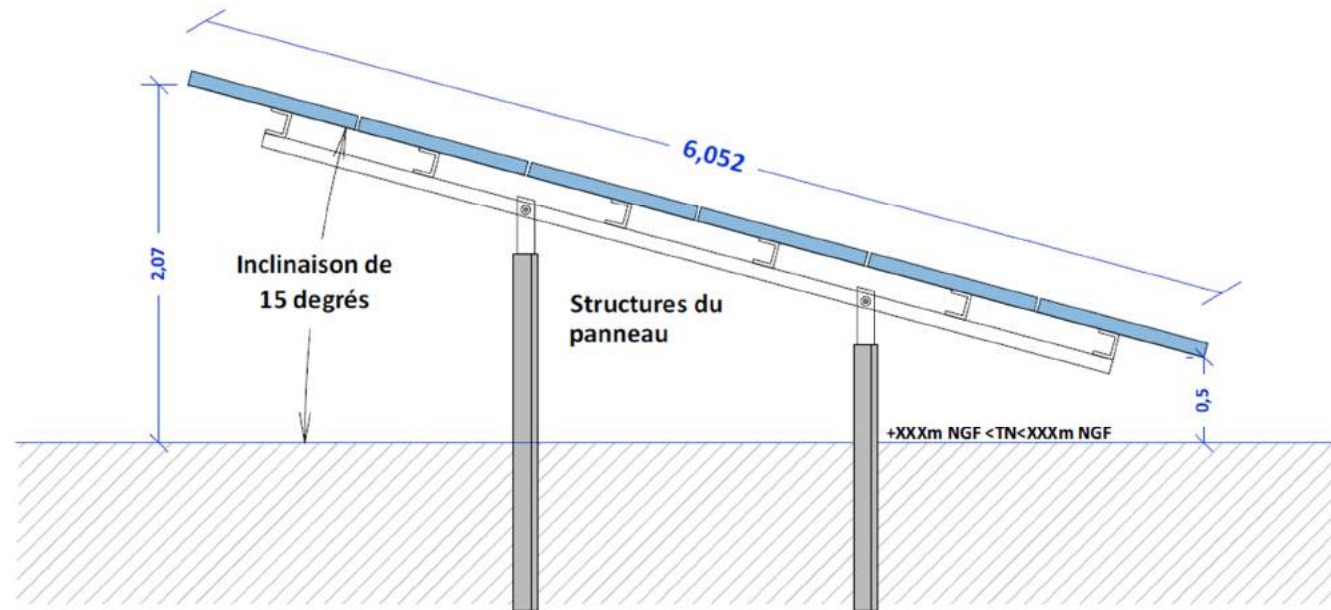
Coupe et plan modèle des structures photovoltaïques
